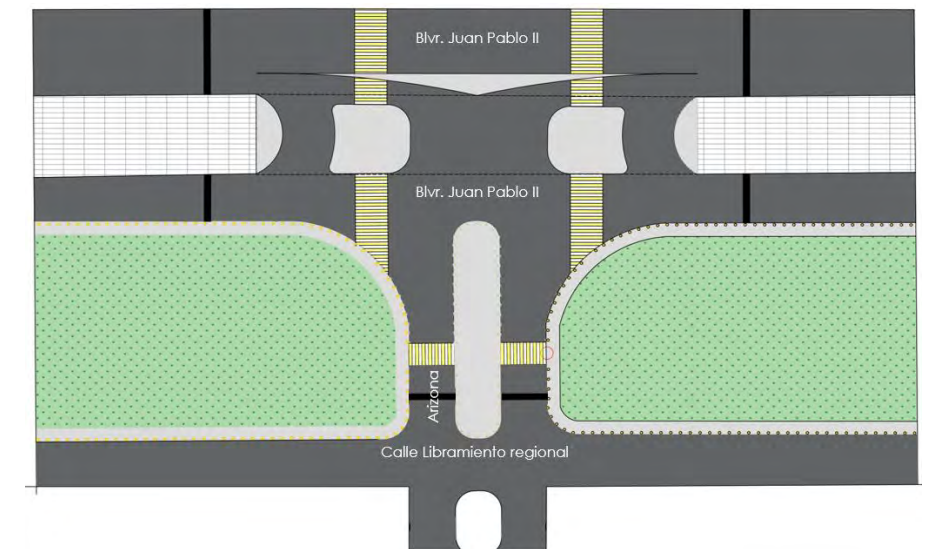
Planta de cruce Juan pablo II y arizona. Elaboración propia
